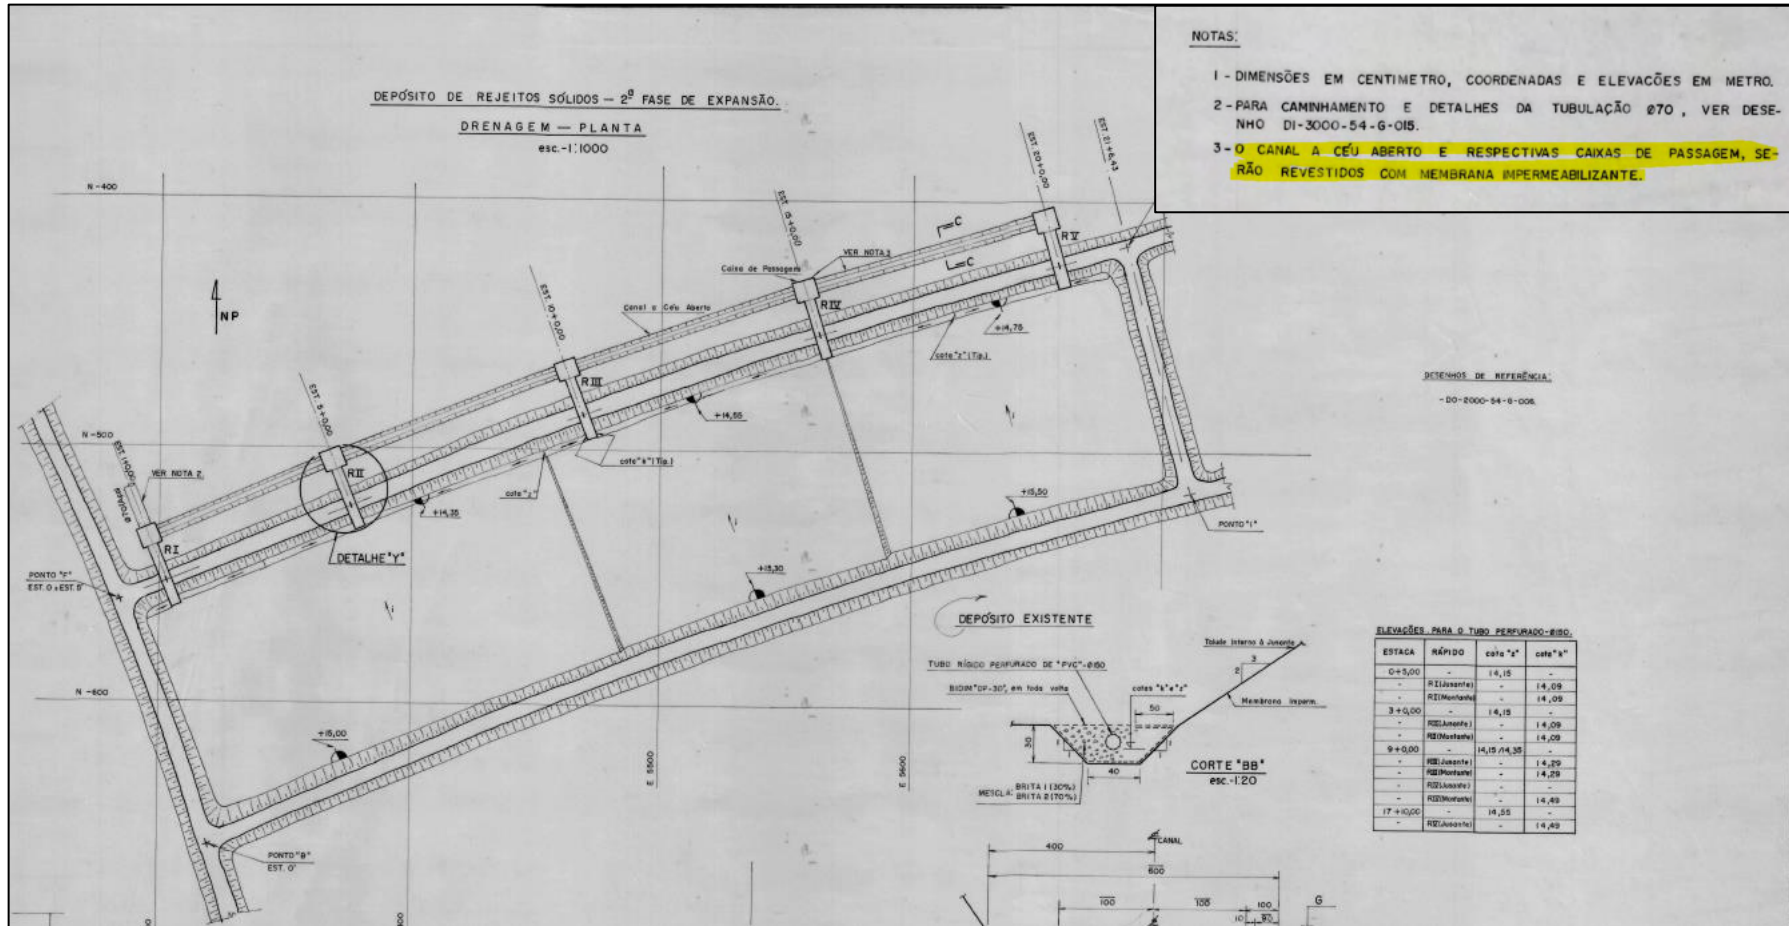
Adaptado de Planta e seções do projeto de drenagem da 2ª fase de expansão DRS1 (D1\_3000\_54\_G\_011\_00\_AREA 54ª)
